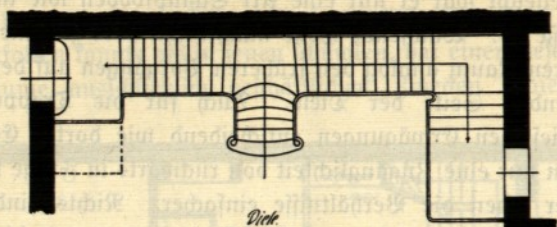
Bremen. Wachstraße, Treppenanlage.
